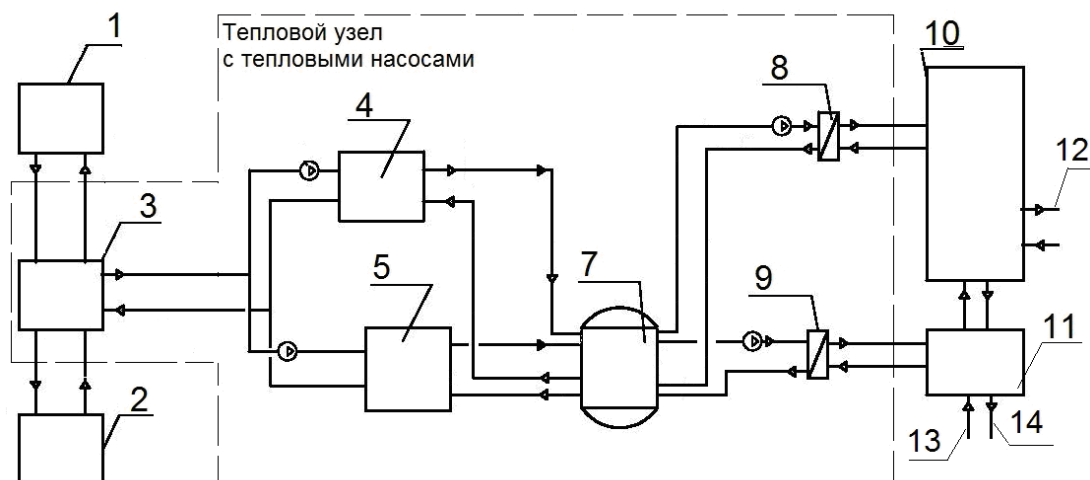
Предлагаемая реконструкция схемы теплоснабжения здания
